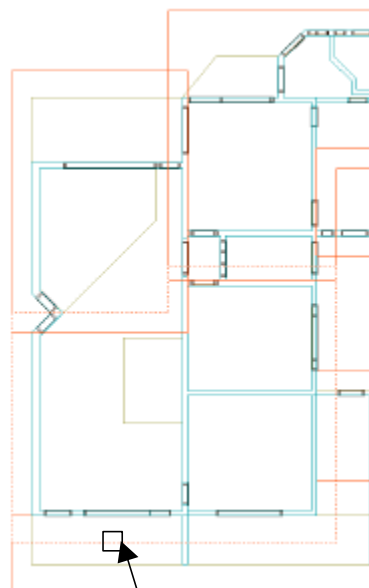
Seleção da primeira água do telhado para ser detalhada
